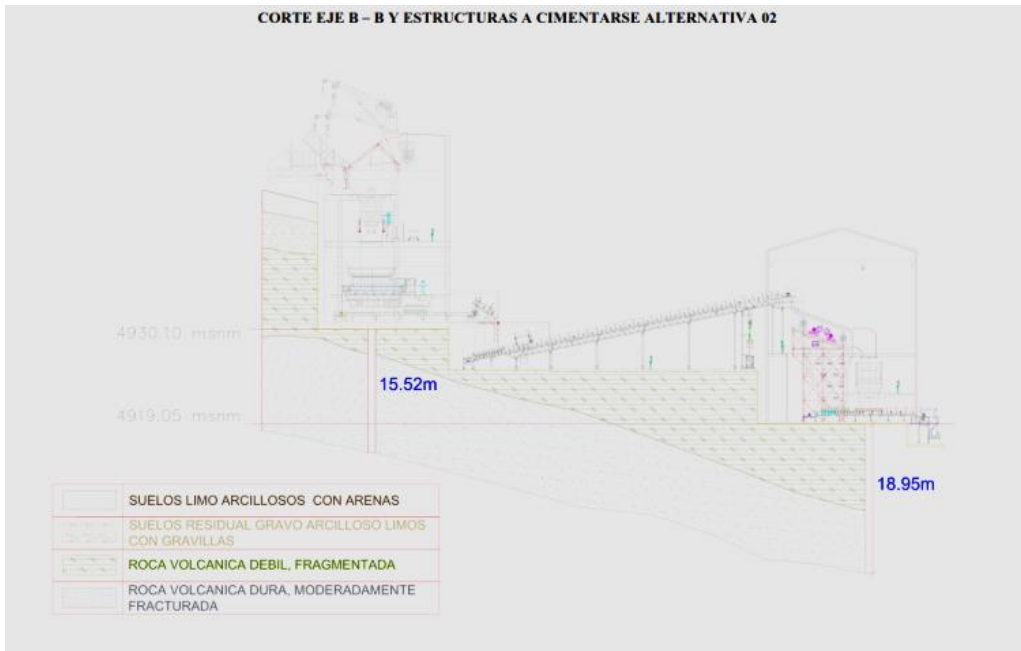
Modelo Geotécnico-perfil estratigráfico de cimentación de la planta.
